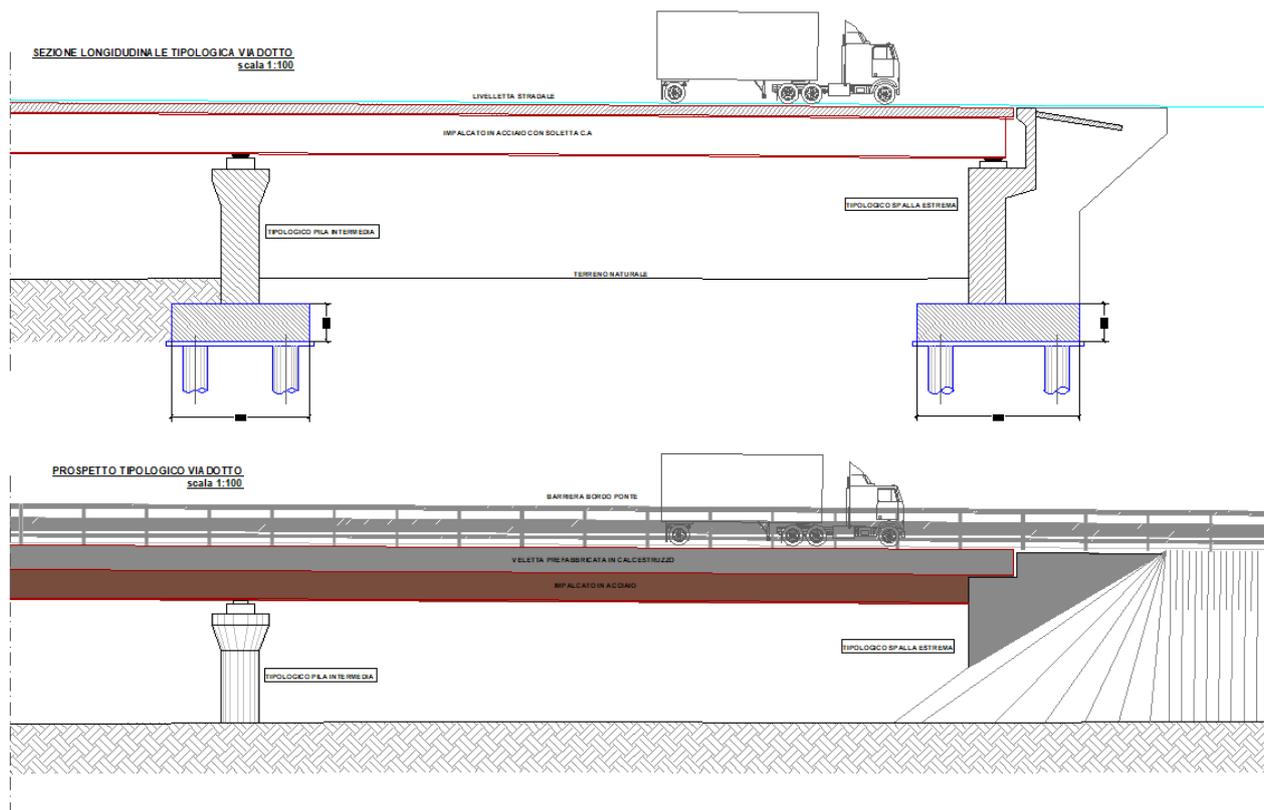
Sezione longitudinale e prospetto tipologico viadotto
